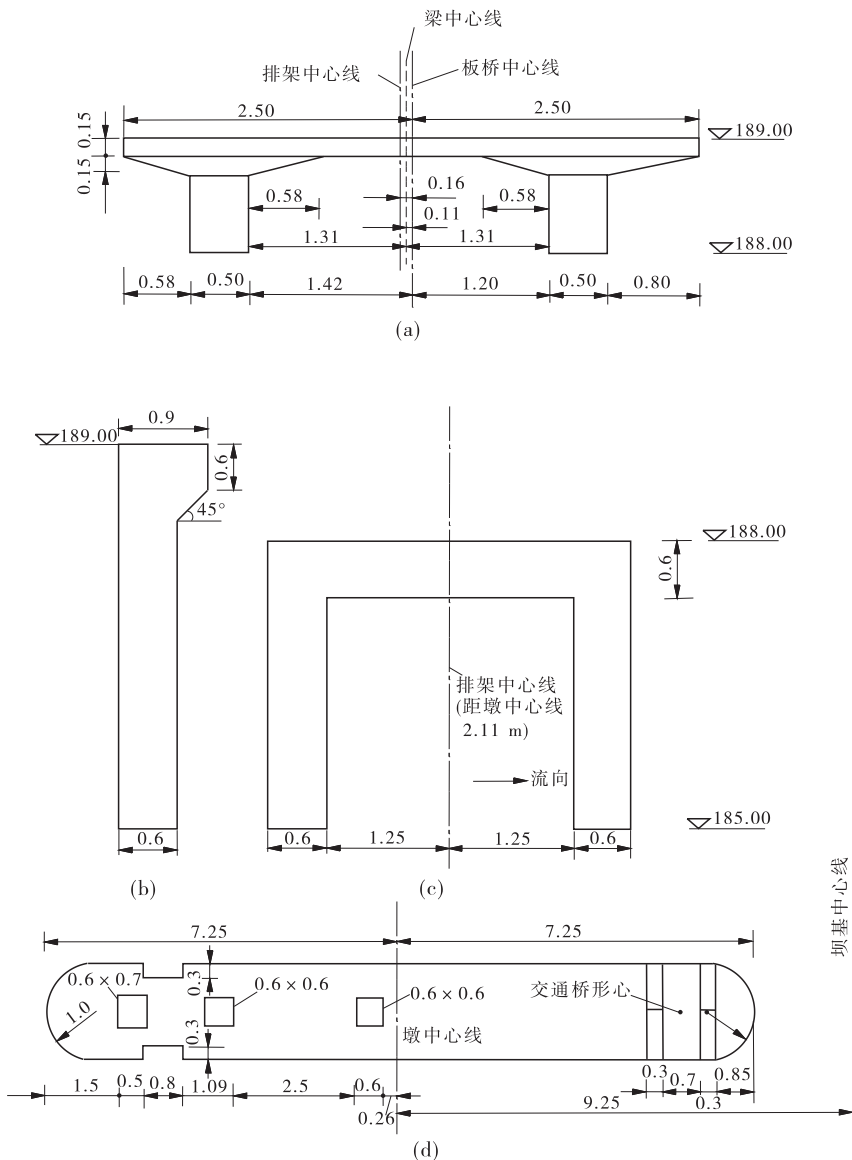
闸墩、工作桥排架尺寸及位置 (单位:m)
